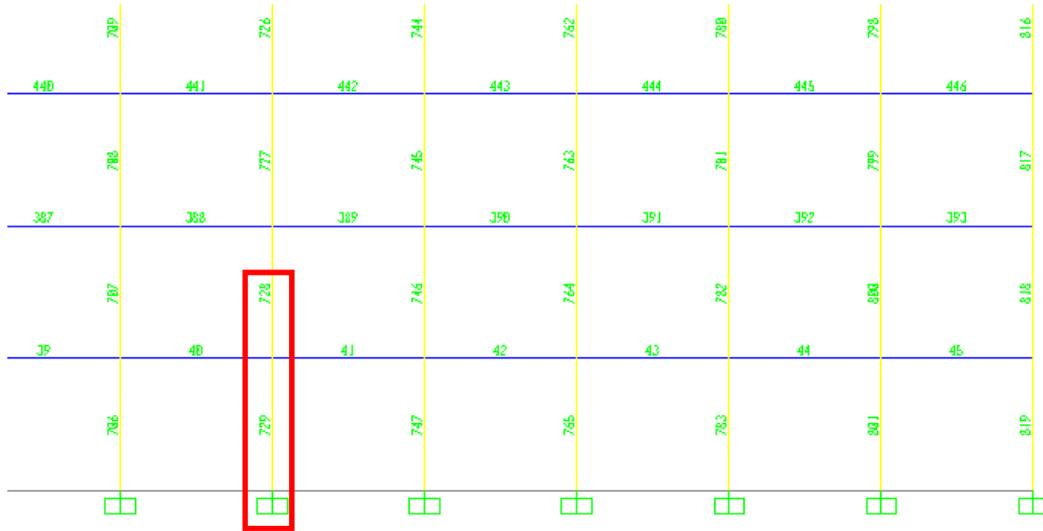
Penulangan Balok Induk Frame 9 & 10
